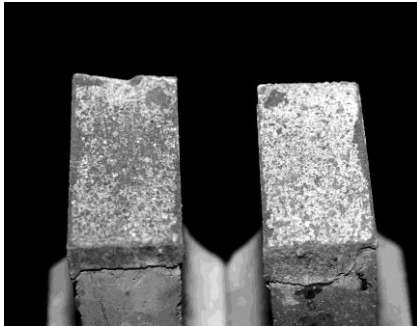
Adhäsives Versagen mit leichten Mörtelrückständen auf dem Beton
